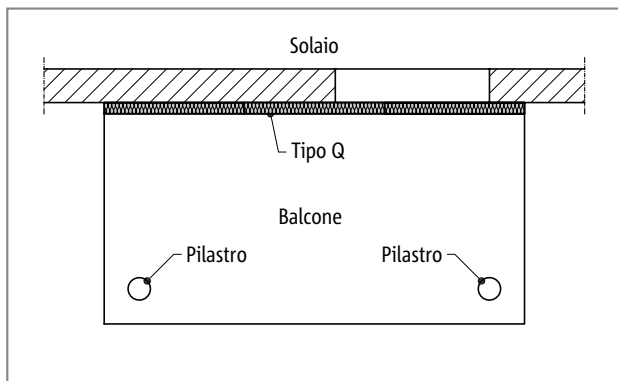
Schöck Isokorb® tipo Q, balcone con appoggio su pilastri
